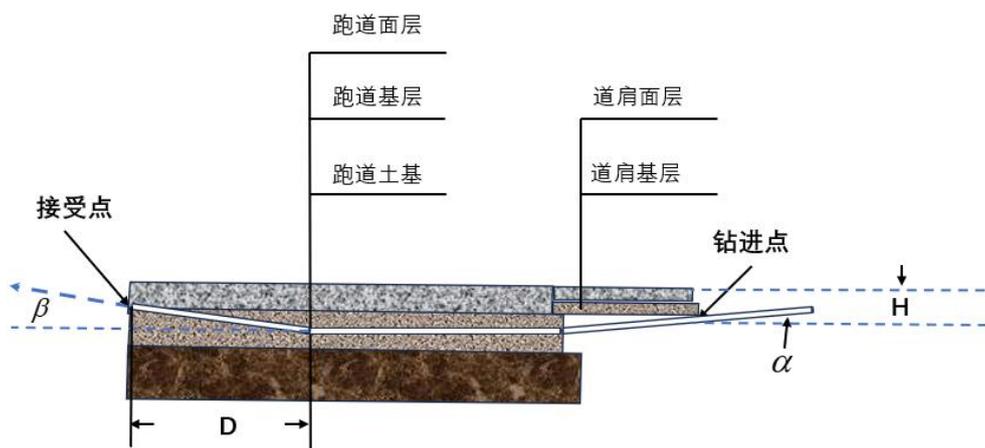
水平定向钻施工剖面图示意图 (跑道为例)
